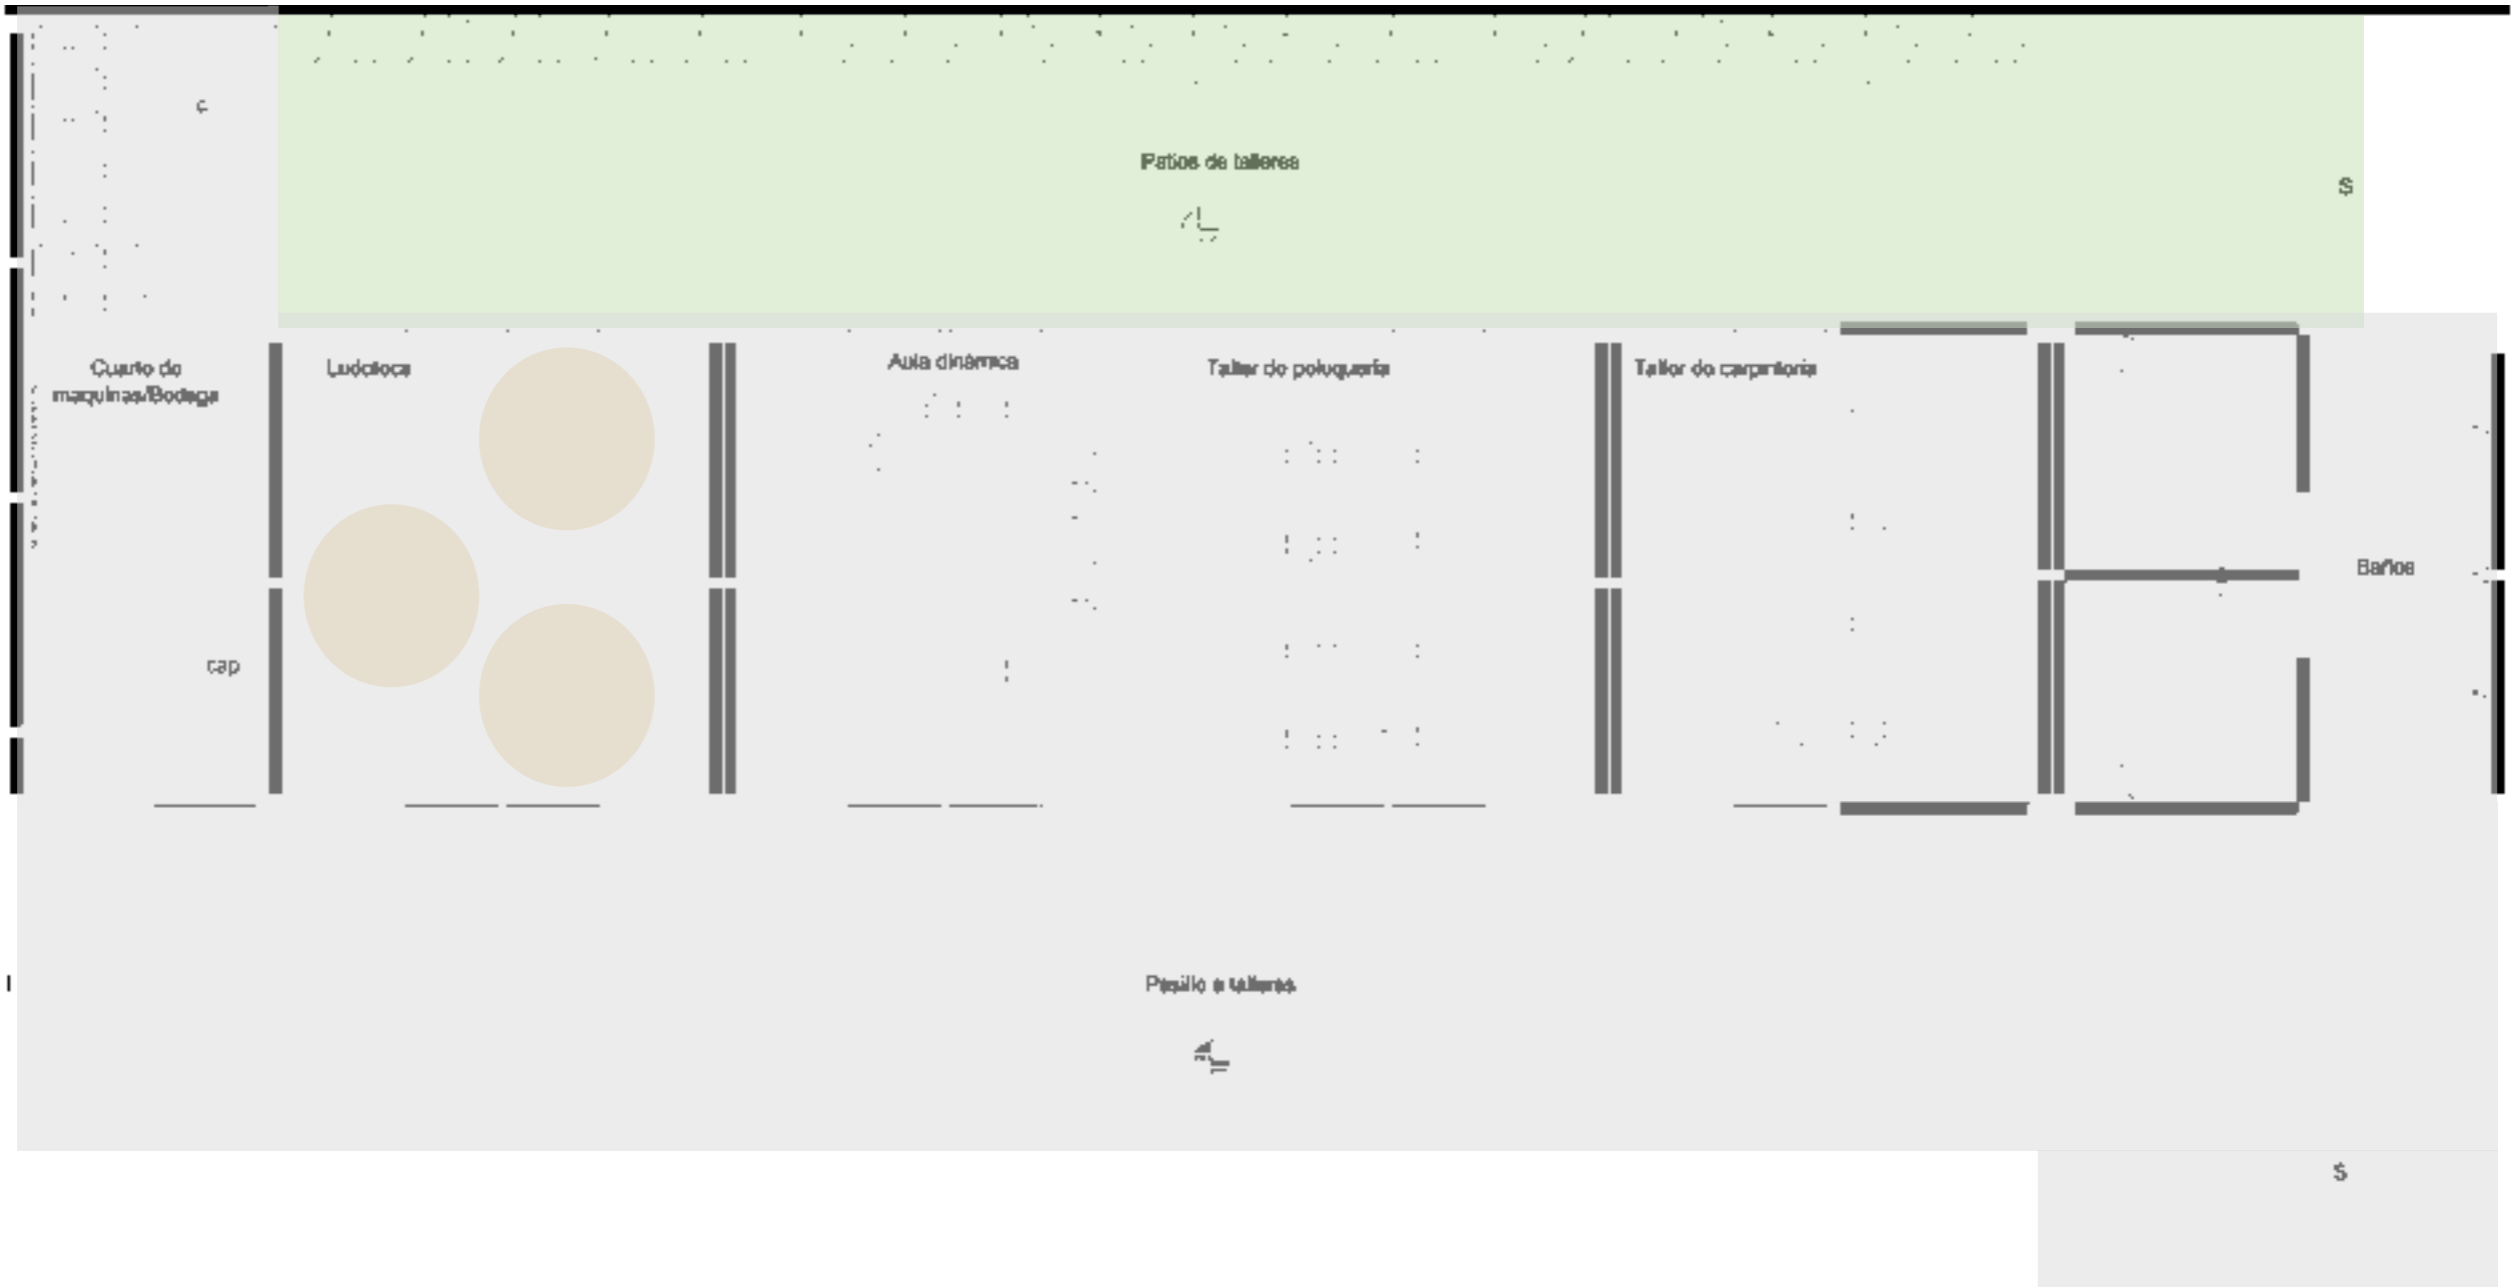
Pisos en planta baja [Ana Lizbeth Arreola Maciel, 2021)
